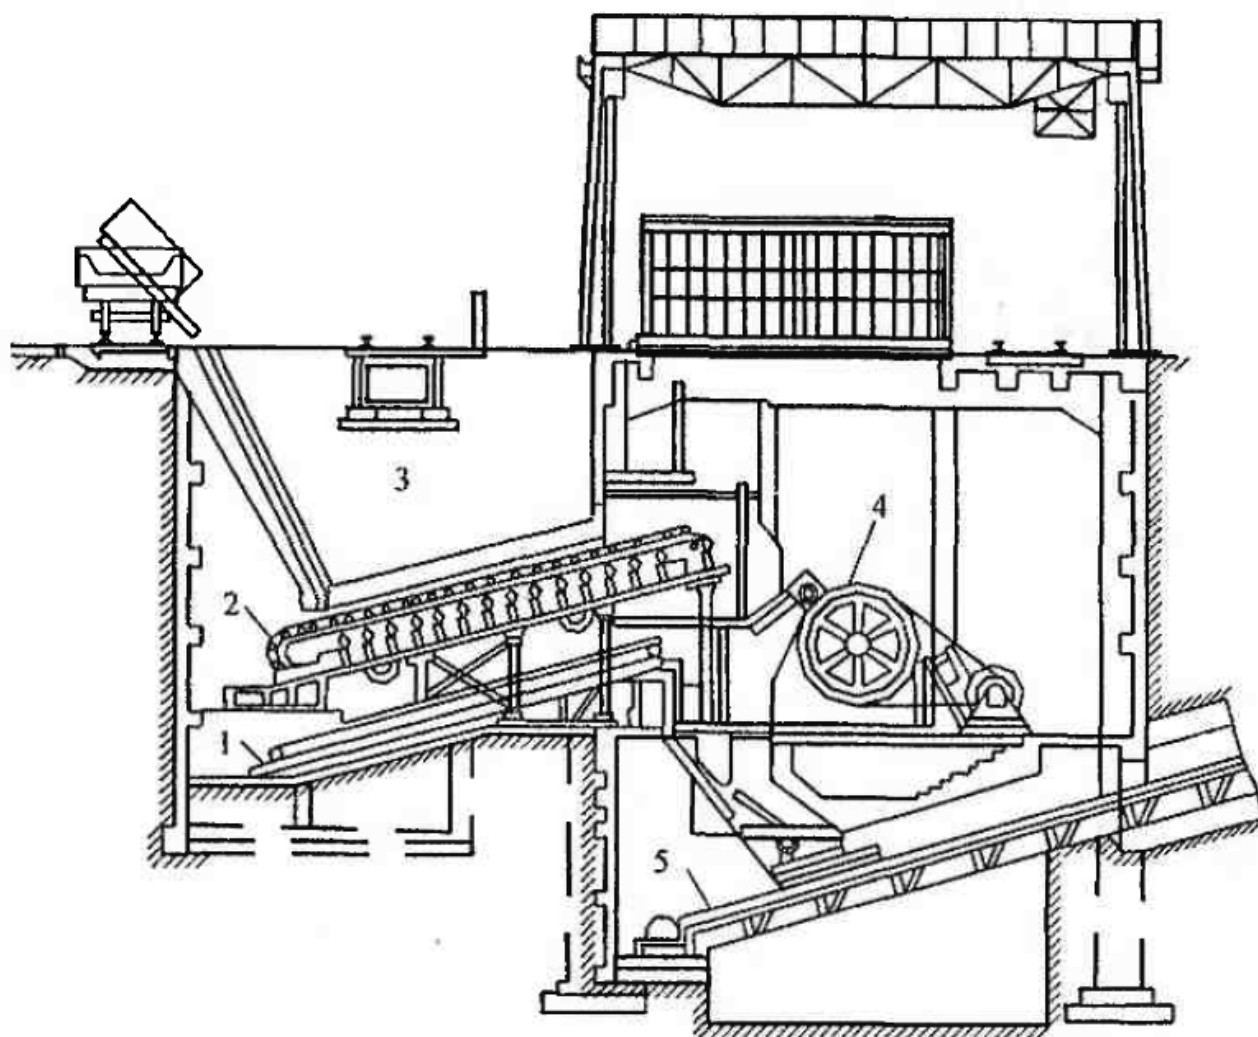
Схема установки щековой дробилки [3]:
